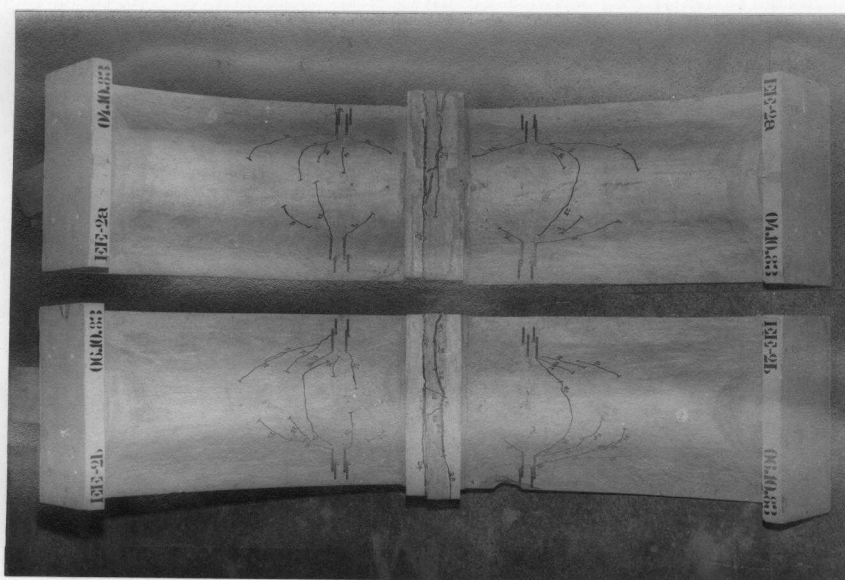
Modelo de emenda por laço - aspecto da face interna após o ensaio.
